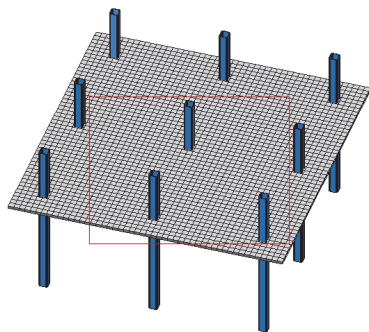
Розрахункова модель залізобетонної плити підсиленої зовнішньо напруженою арматурою
